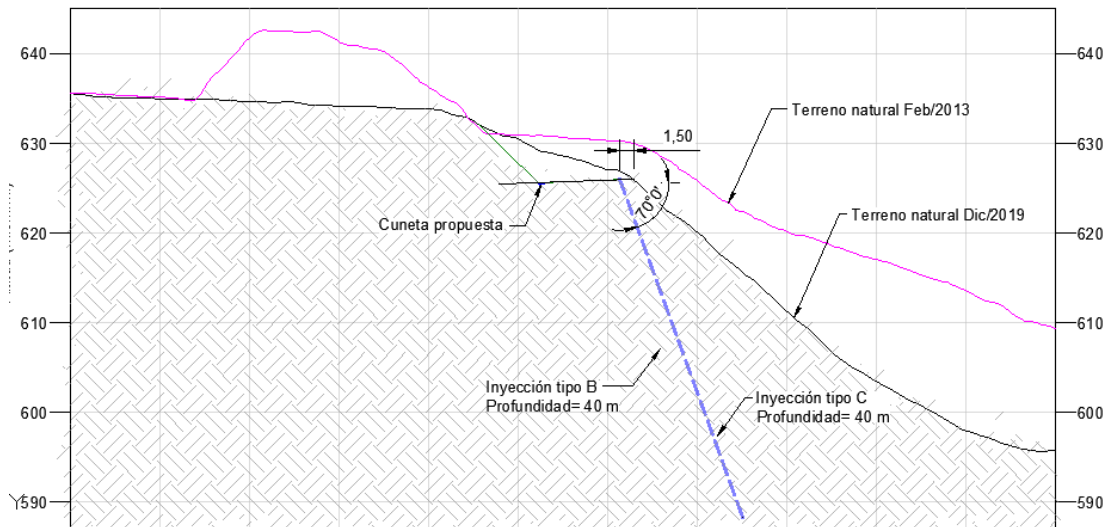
Perfil A – Inclinación inyecciones y longitud.
